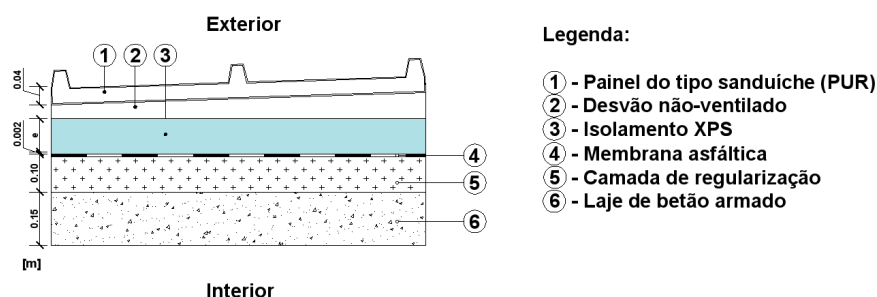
Pormenor da cobertura sobre a nave principal, com a aplicação do isolamento térmico
